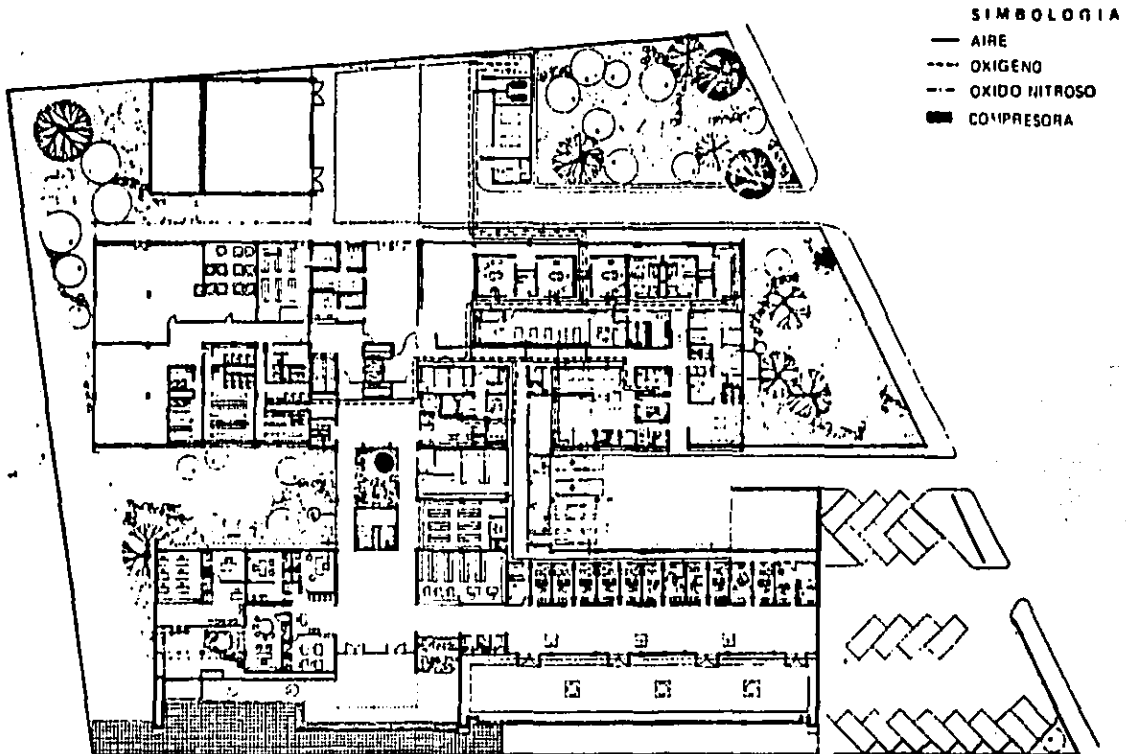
Planta Arquitectónica de Hospital General de Zona con Instalación de Oxígeno y Vacío.
